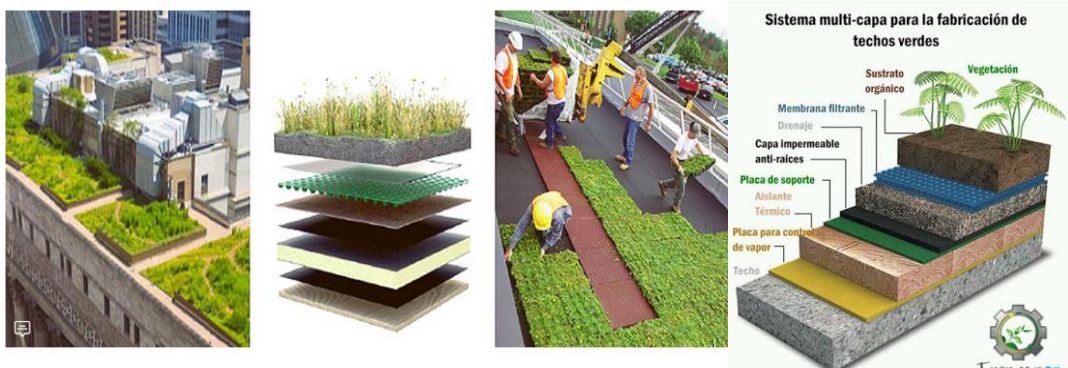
Cubiertas verdes. Fuente: Glasstech (2017).
